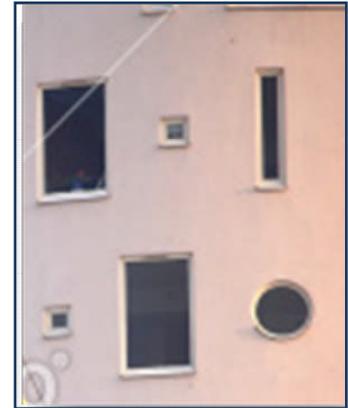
La baie moderne : un trou dans la façade (source : www.istockphoto.com)
